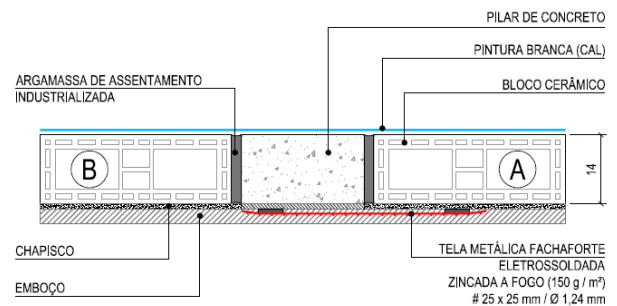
Corpo de prova com utilização de tela metálica no revestimento - planta
